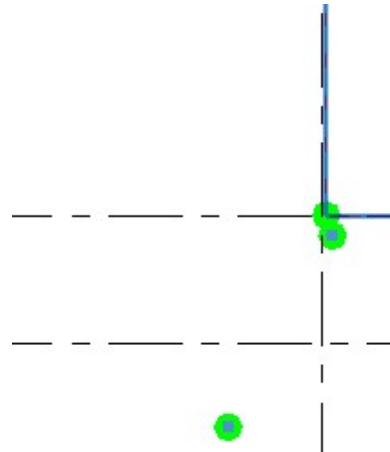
Ajuste analítico entre vigas, laje e pilar.
